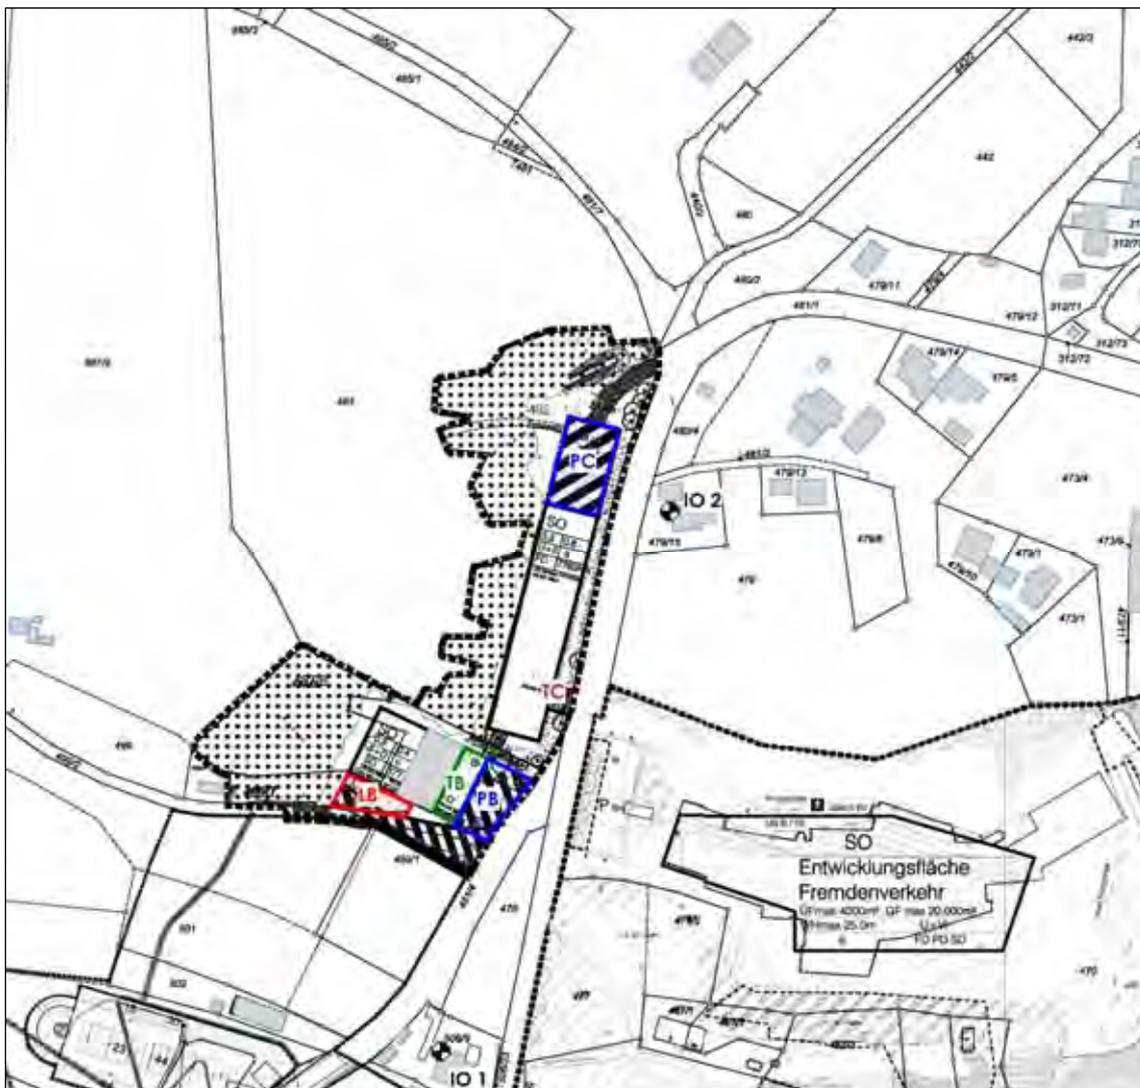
Lageplan mit Darstellung der Schallquellen im SO "Bergglashütte"
